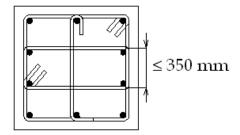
Refuerzo longitudinal y transversal de las columnas.
